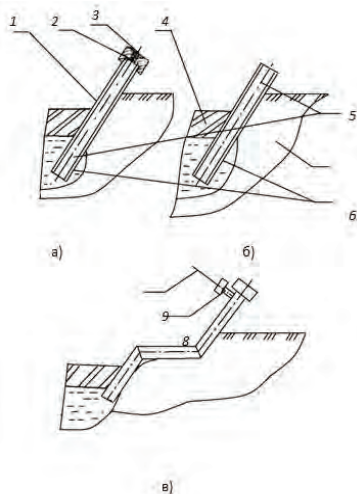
Зимний водозабор водоема, где: а) общий вид; б) со снятой крышкой; в) в сопряжении с патрубком насосного агрегата или компрессора
